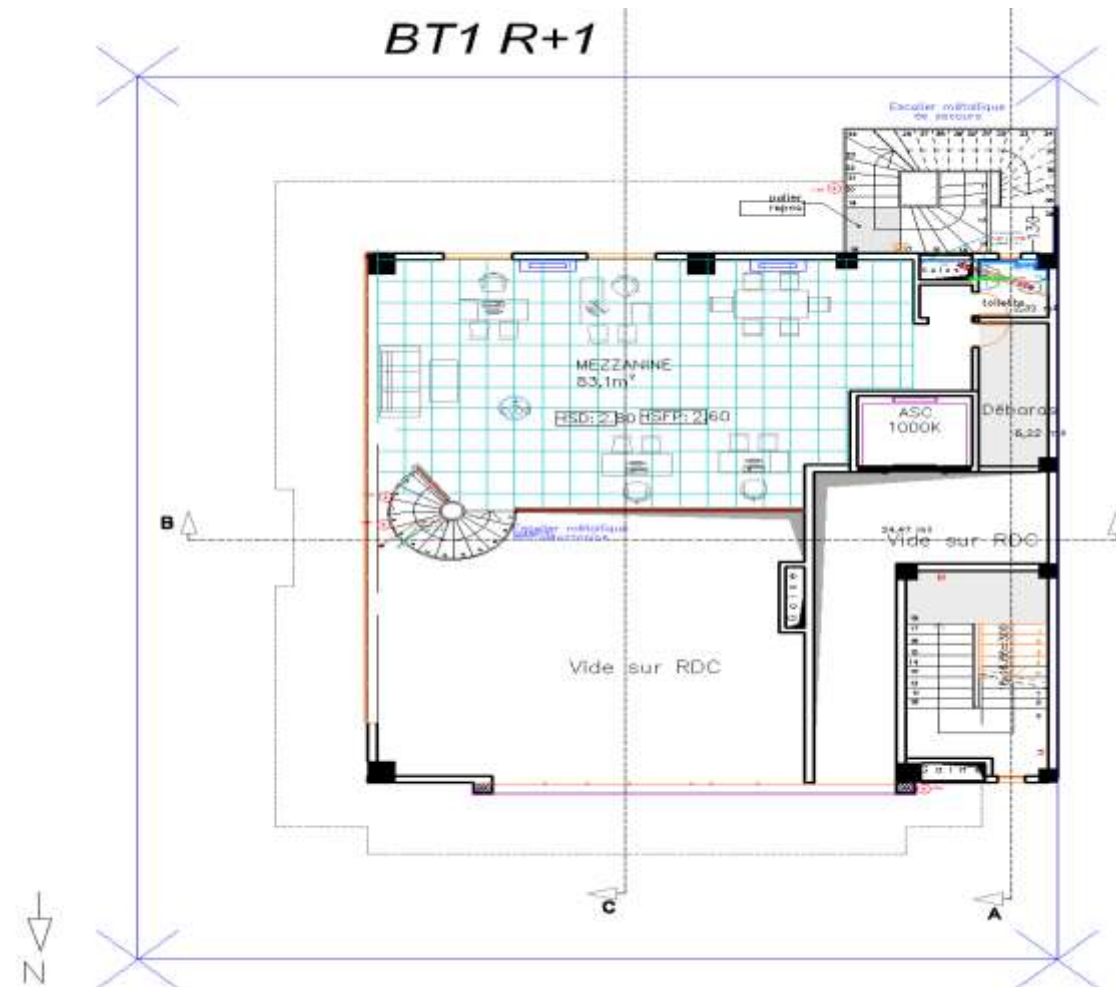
Plan du Bâtiment Tertiaire 1 niveau R+1
